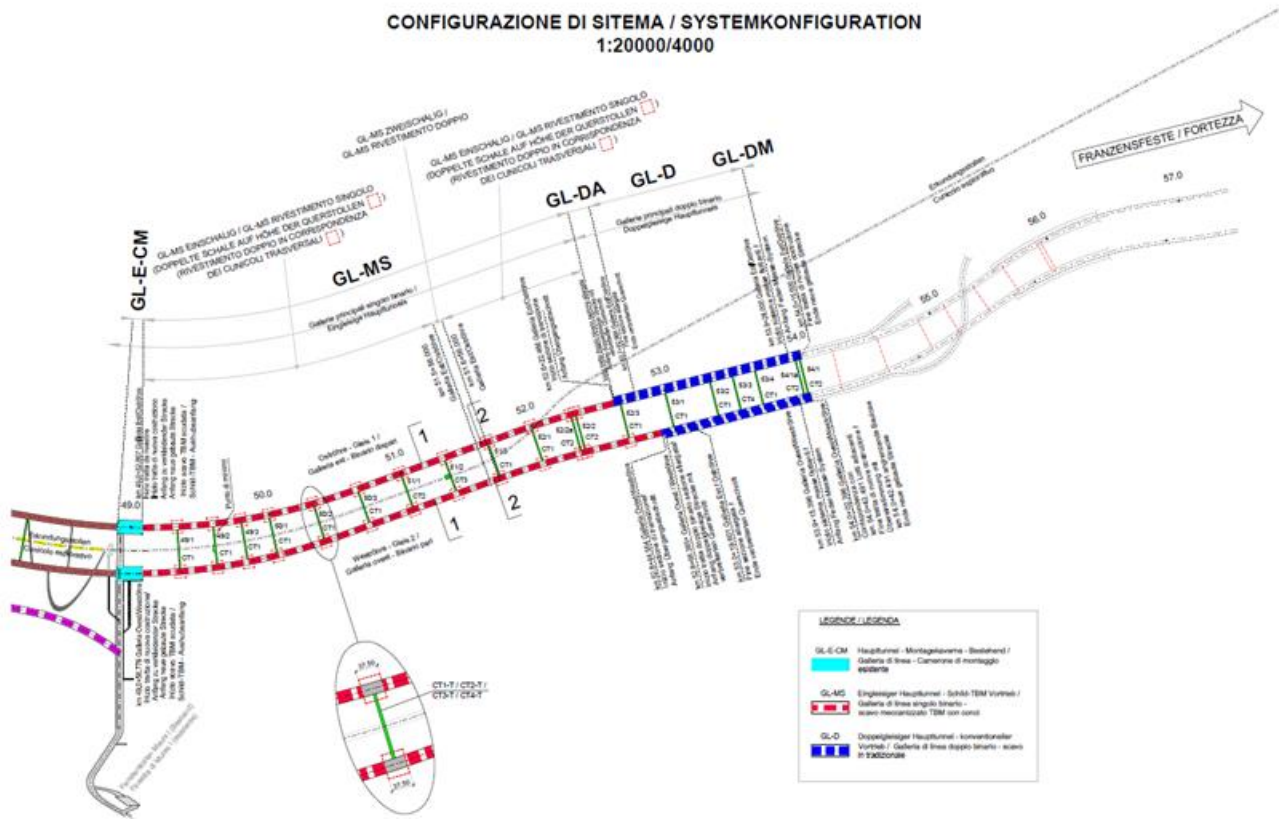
TBM Option Strecke Süd - Lageplan Querschnitte Schild
